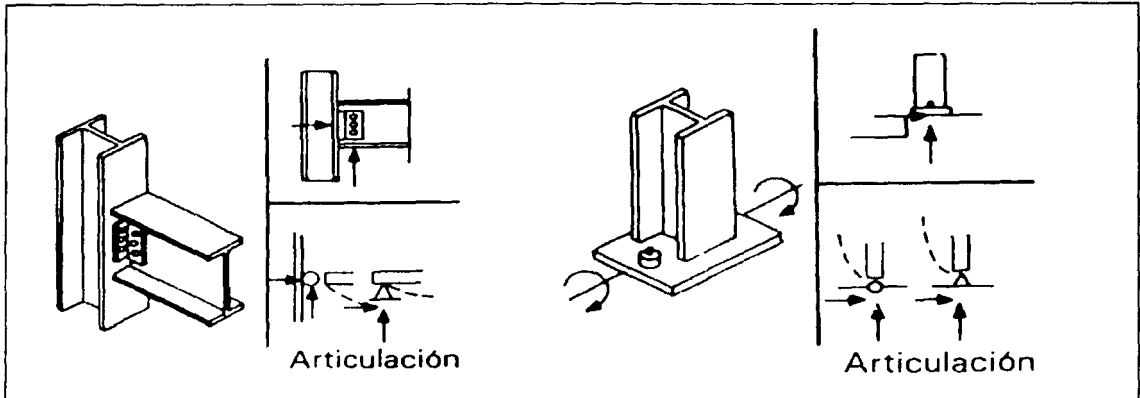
Conexiones columna-cimentación en acero
